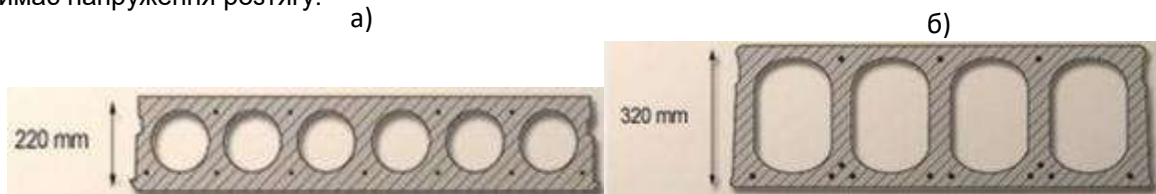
Види багатопустотних плит перекриття у перерізі: з круглими порожнинами (тип ПК)-а, з овальними порожнинами – б
